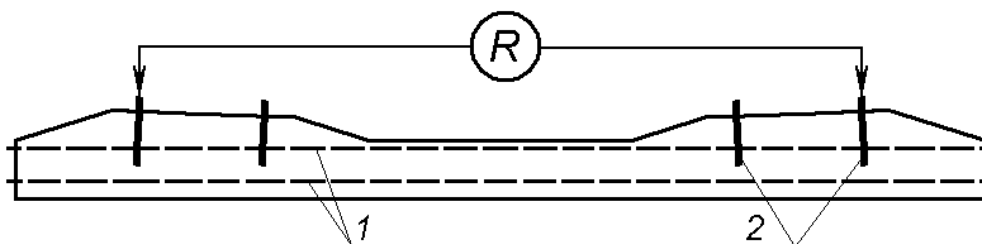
Схема вимірювання електричного опору залізобетонних шпал: 1 – розташування арматурного пакету; 2 – закладні болти скріплень КБ або анкери скріплень КПП-5 і УС-1
